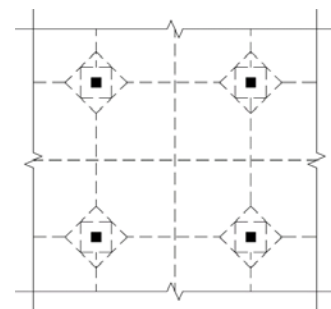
Механизмы разрушения безбалочной плиты перекрытия со скрытыми капителями
